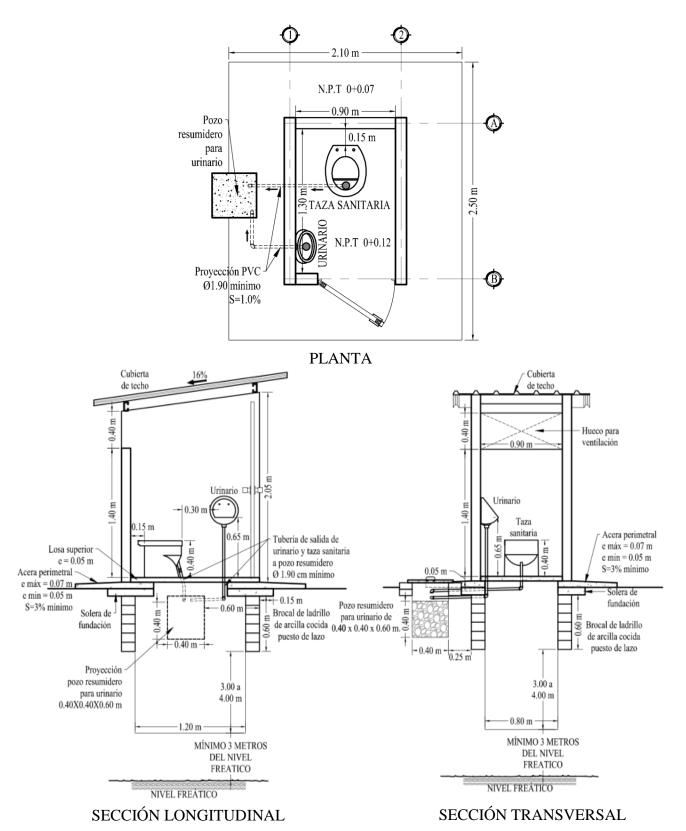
Vista en planta y elevación de los detalles constructivos de letrina de hoyo
